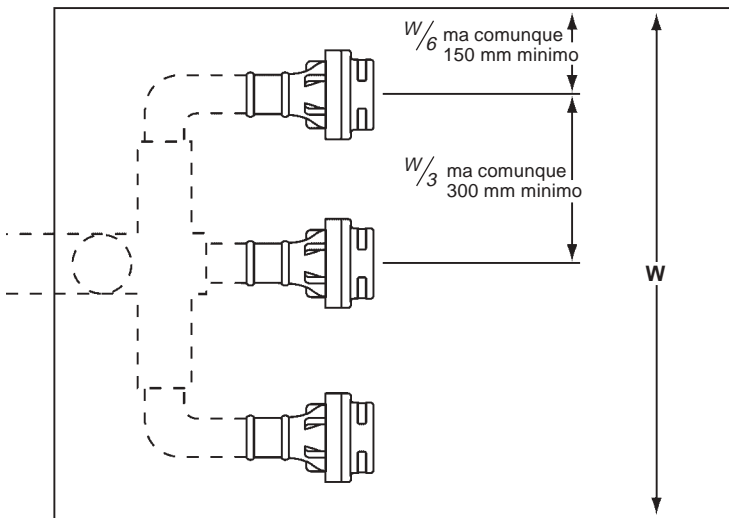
Installazione con tre iniettori in parallelo (vista in pianta)
